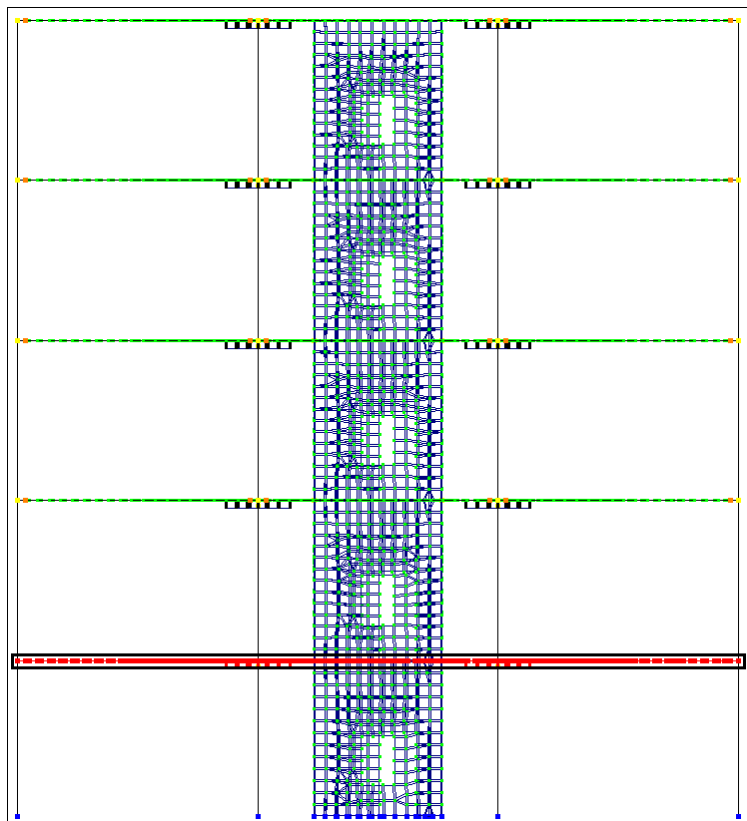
Выделение плиты перекрытия 1-го этажа
